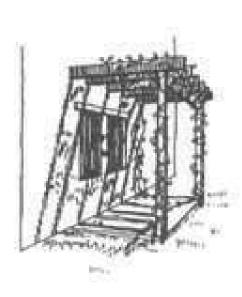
29: Protección natural mediante la construcción de estructuras que serán cubiertas en verano por setos verdes, los que darán la sombra prevista.
